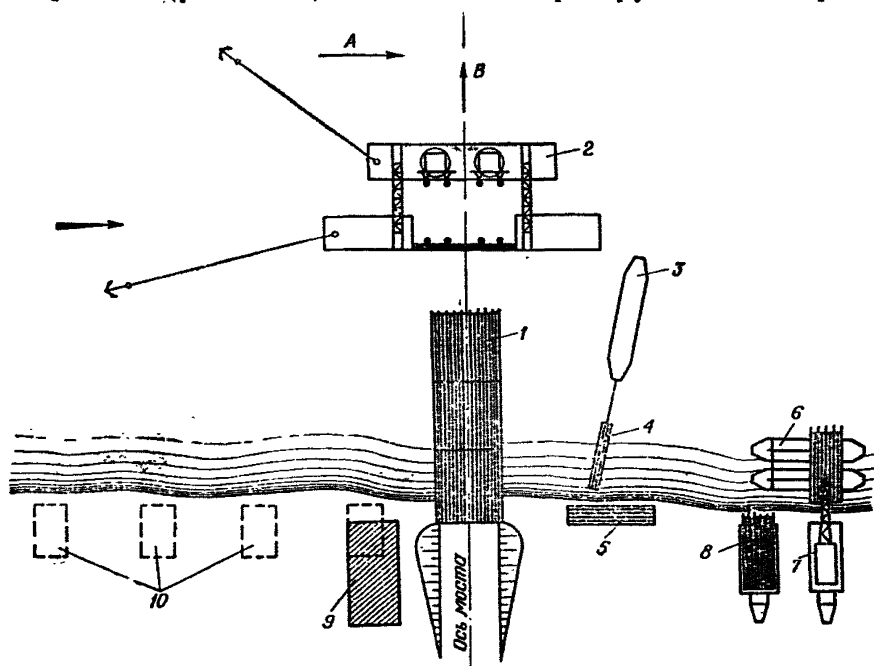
Схема организации строительной площадки при строительстве моста на свайных опорах:
